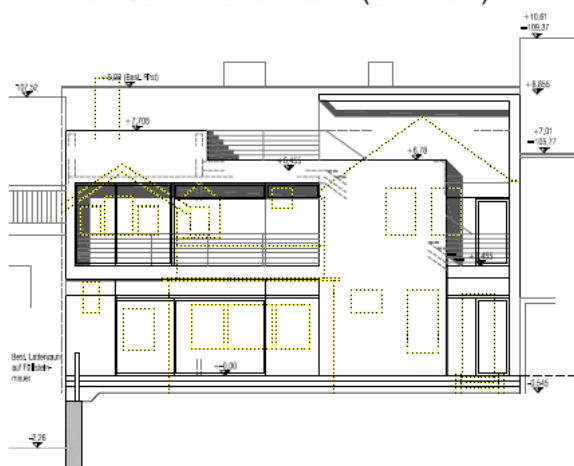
Adaptierung eines Einfamilienhauses in Tulln
